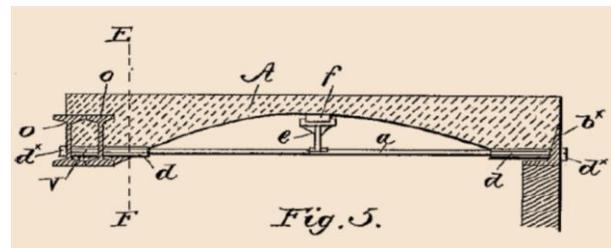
Vorgespanntes Betonelement nach Jacksons Patent [13, S.422 Bild 1]
